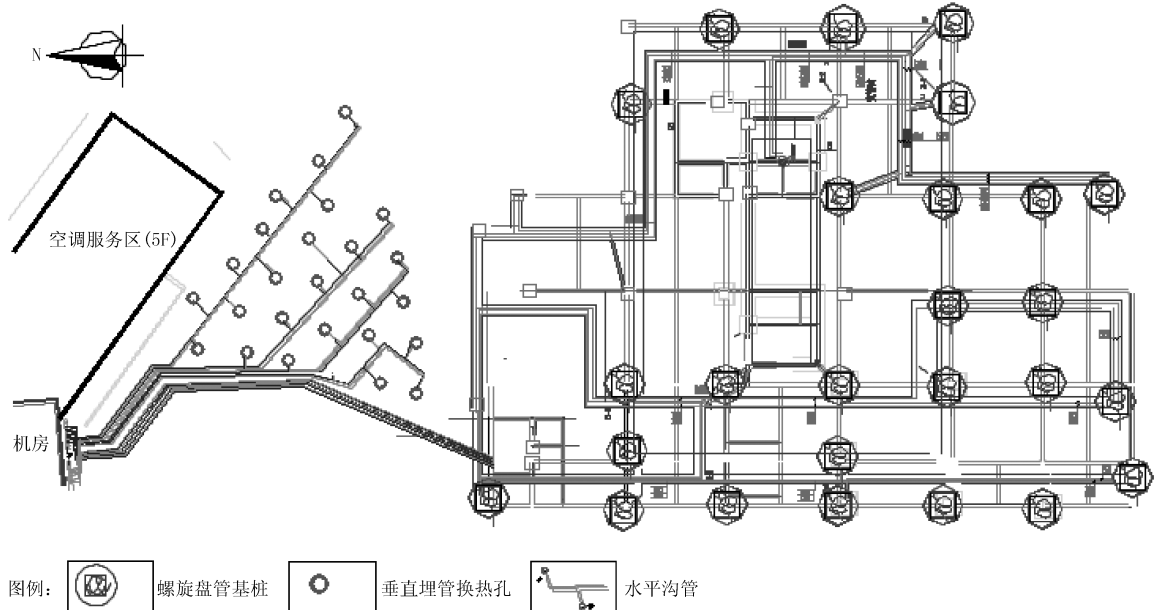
垂直埋管与桩螺旋盘管有效组合平面布置图
